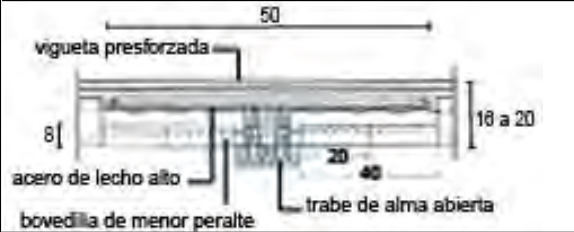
Apoyo con capitel en franja equivalente a dos bovedillas rebajadas (40cm de ancho).
